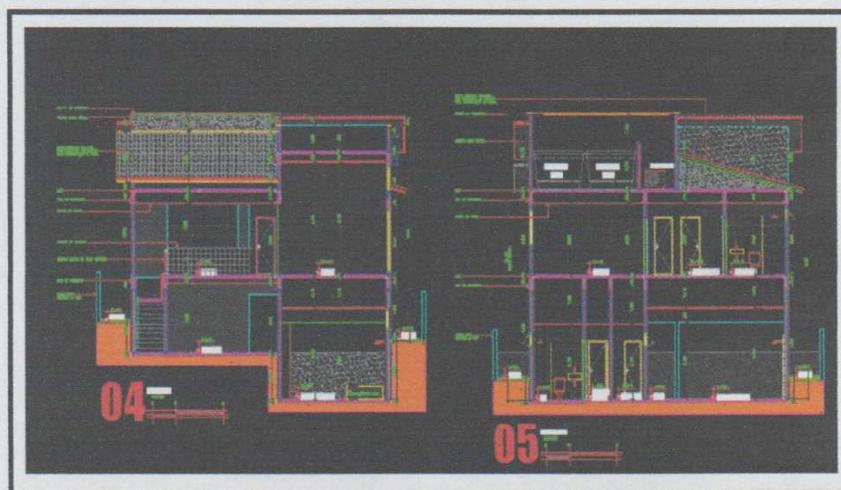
Elaboração de cortes utilizando a ferramenta CAD
